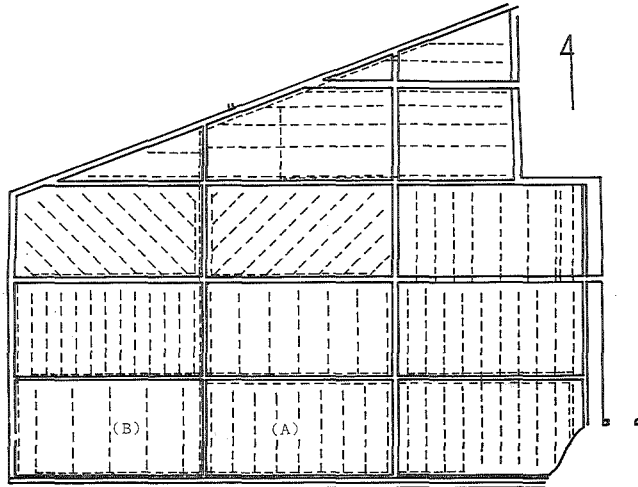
京都大学附属 高槻農場平面図及び暗渠配置図
